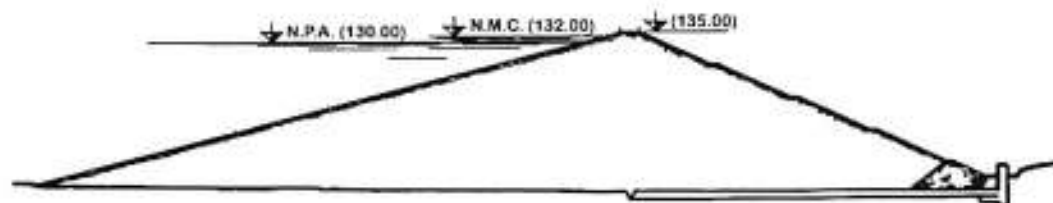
Perfil transversal da barragem do Santa Clara (Fonte: portal INAG – Barragens de Portugal)
